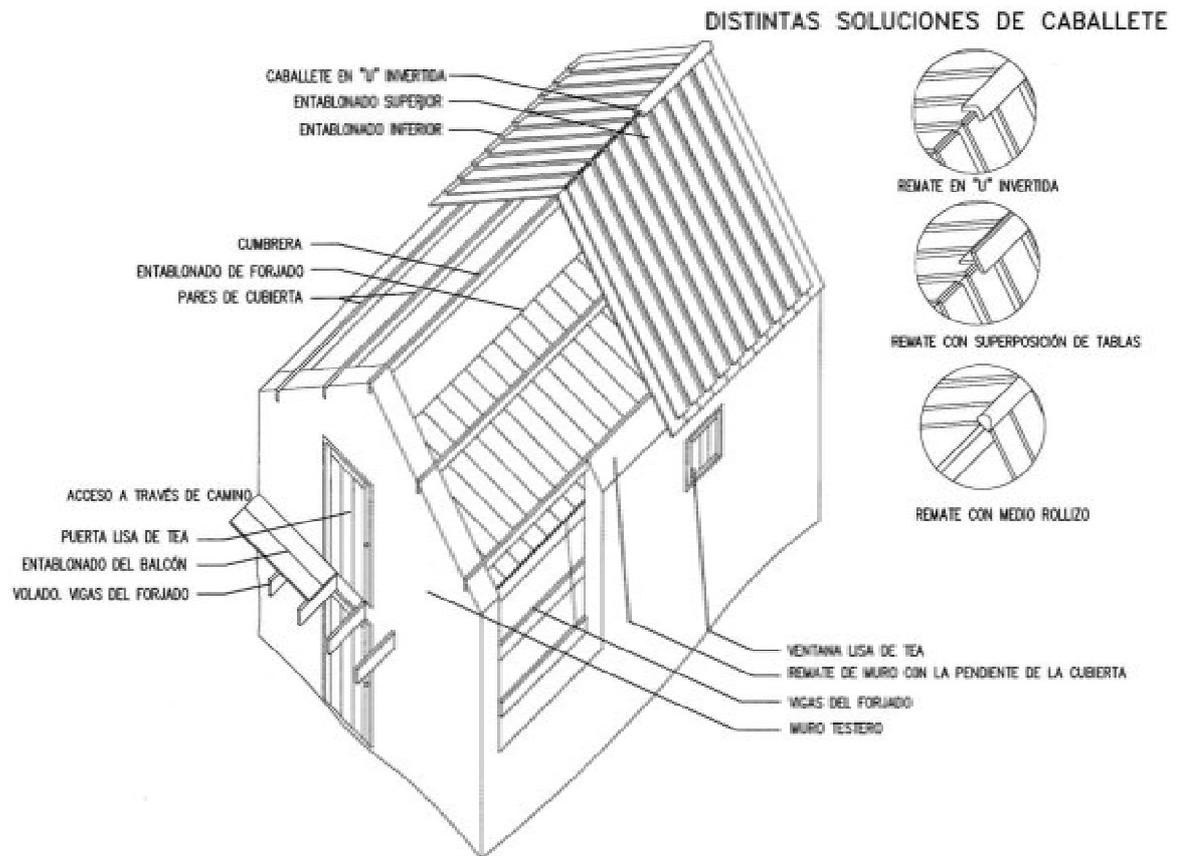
Vivienda de dos plantas con estructura de muros de piedra y cubierta de madera. (Hernández Delgado 2005)
